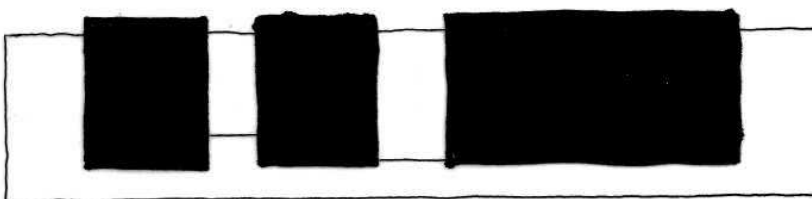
y 55 Diagramas de los planos y volúmenes sólidos en alzado y planta
